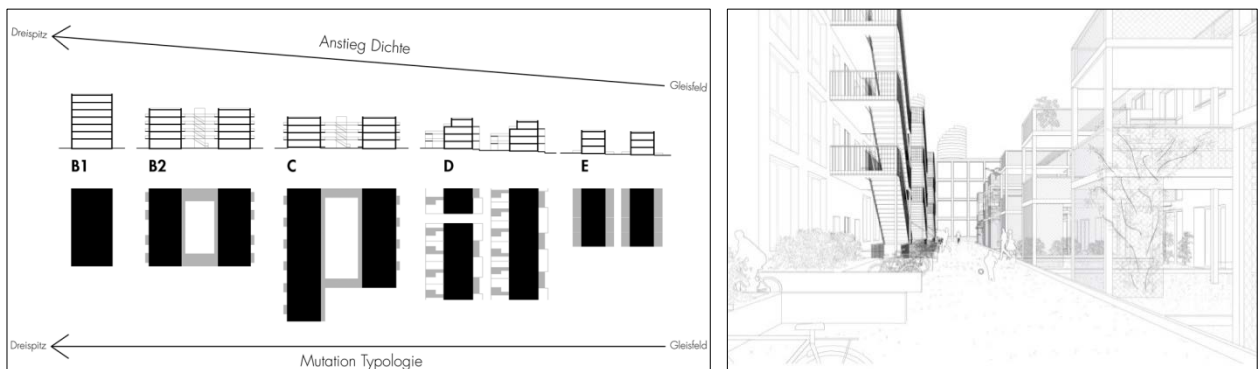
und 6: Erläuterungsskizzen Stand: Abschluss Studienverfahren © camponovo baumgartner architekten gmbh
